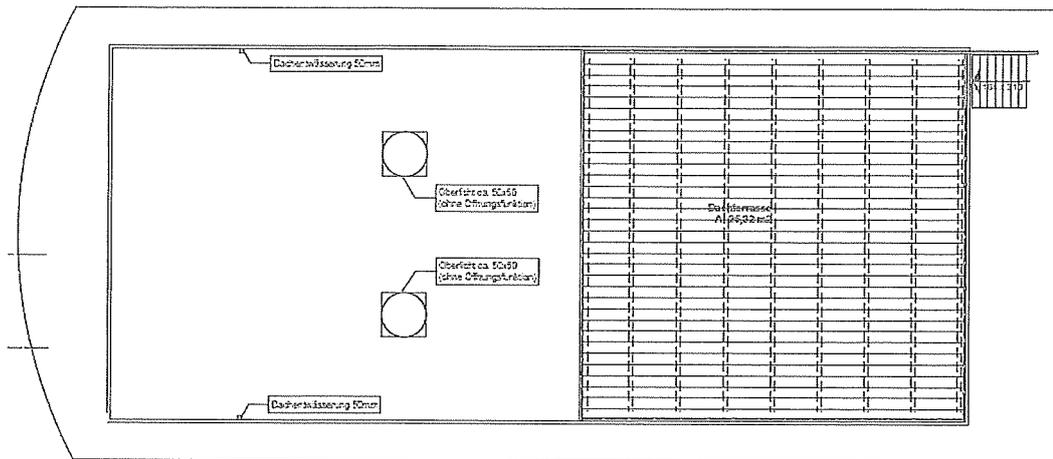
Grundriss der Dachterrasse des FH 44
